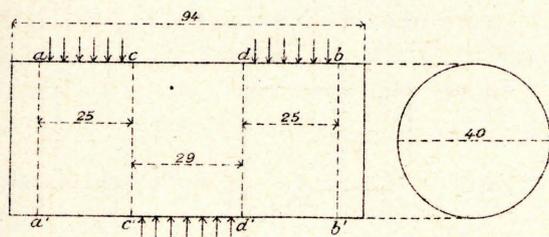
Provetta cilindrica, tipo A. — Scala di 1/2.
